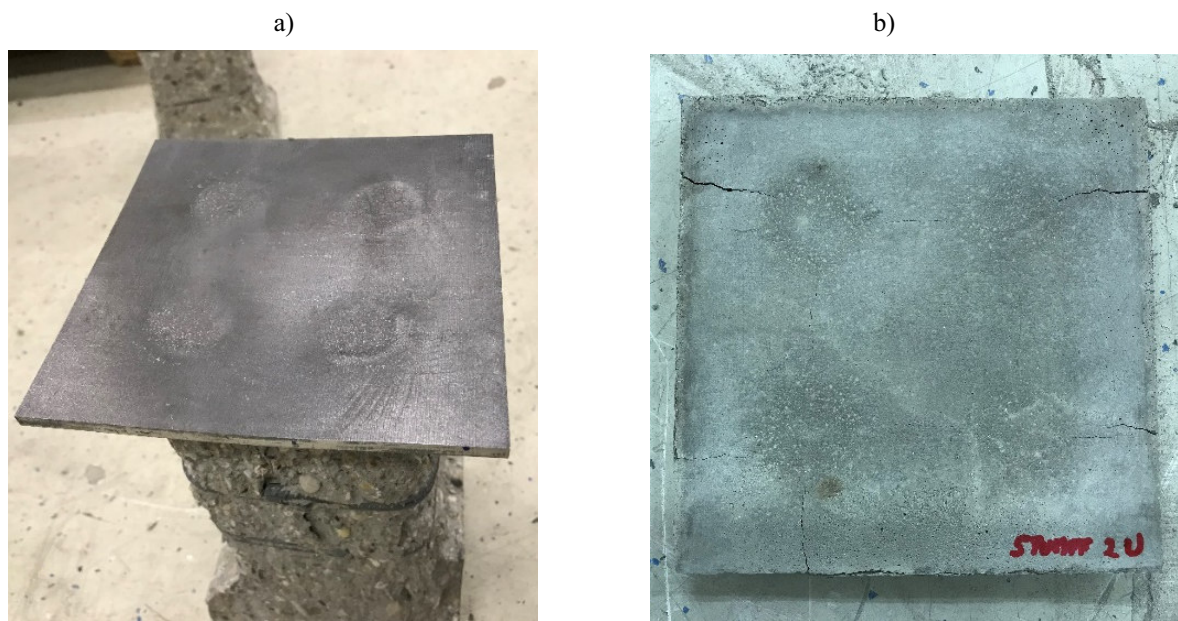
Eindrückungen der hochfesten Bewehrungsstäbe, a) Stahlplatt, b) Mörtelfuge
